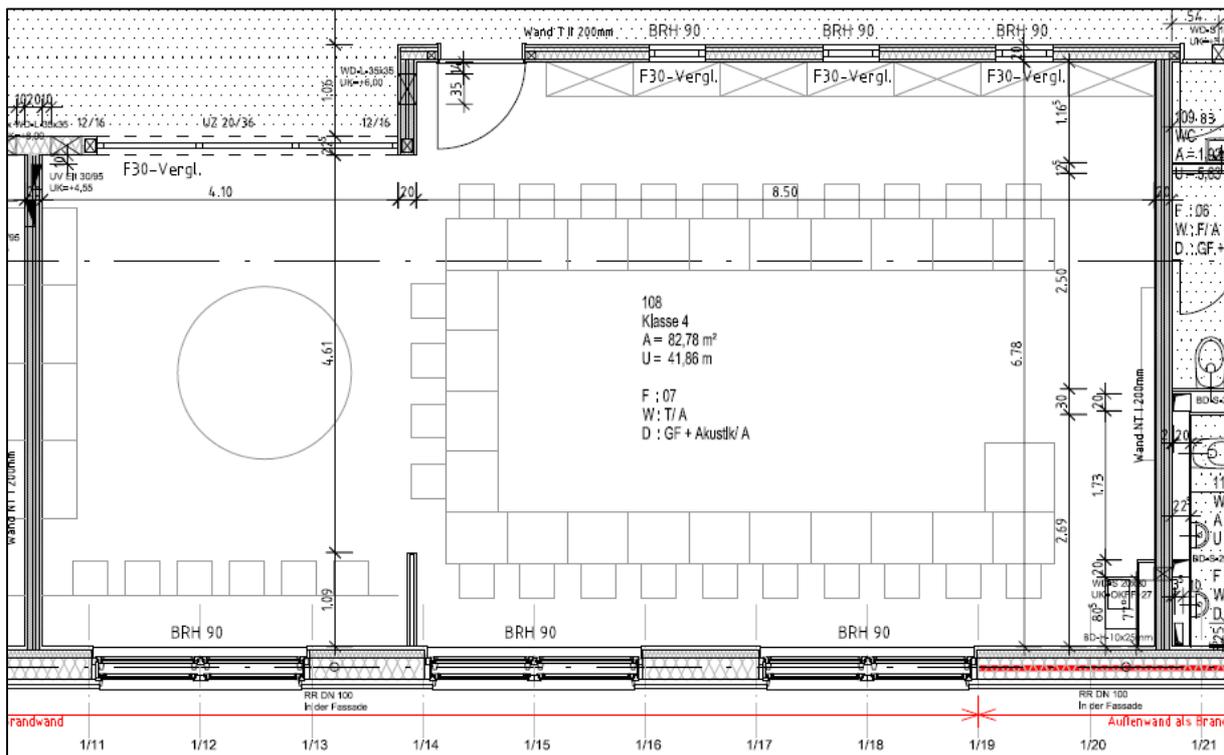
Grundriss Klassenraum 1.08
